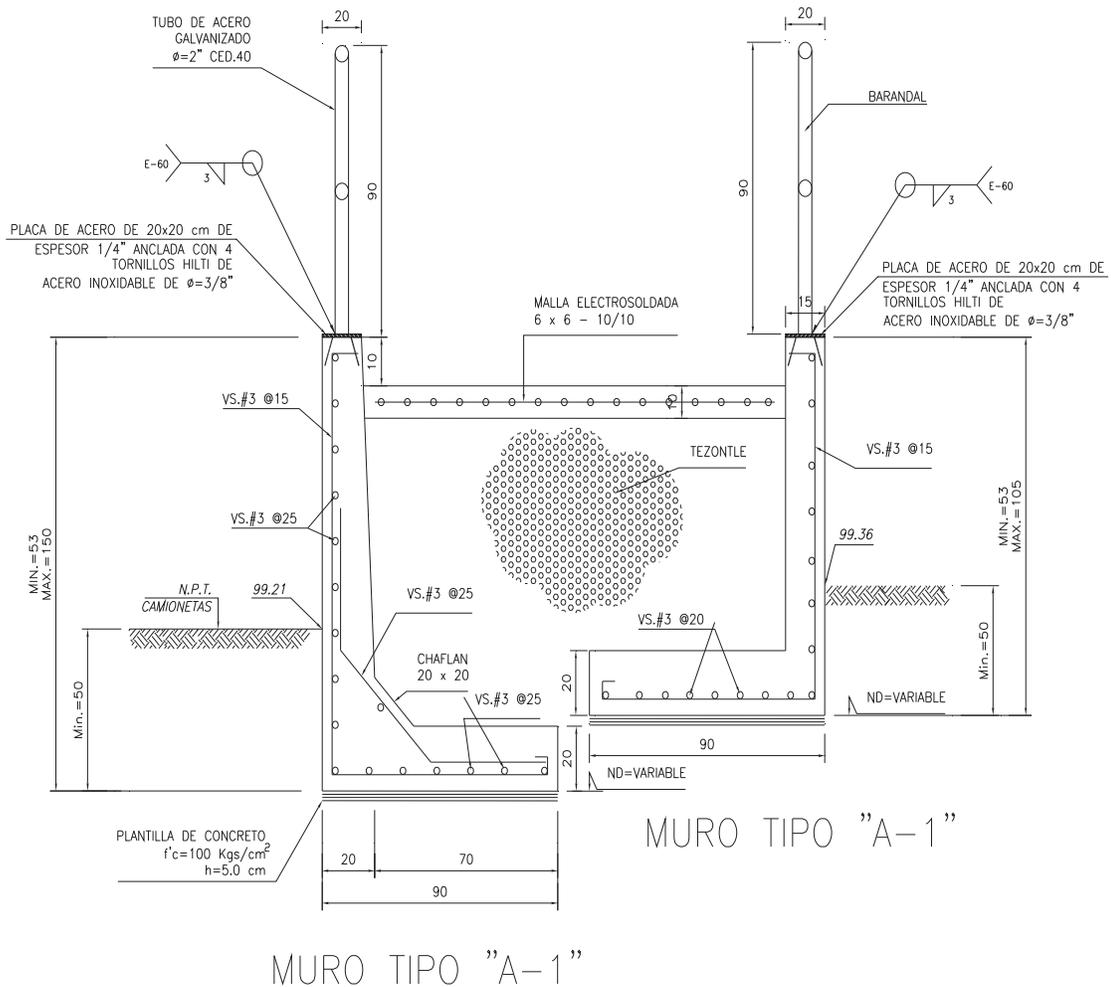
Corte de los muros que forman la rampa del almacén.
